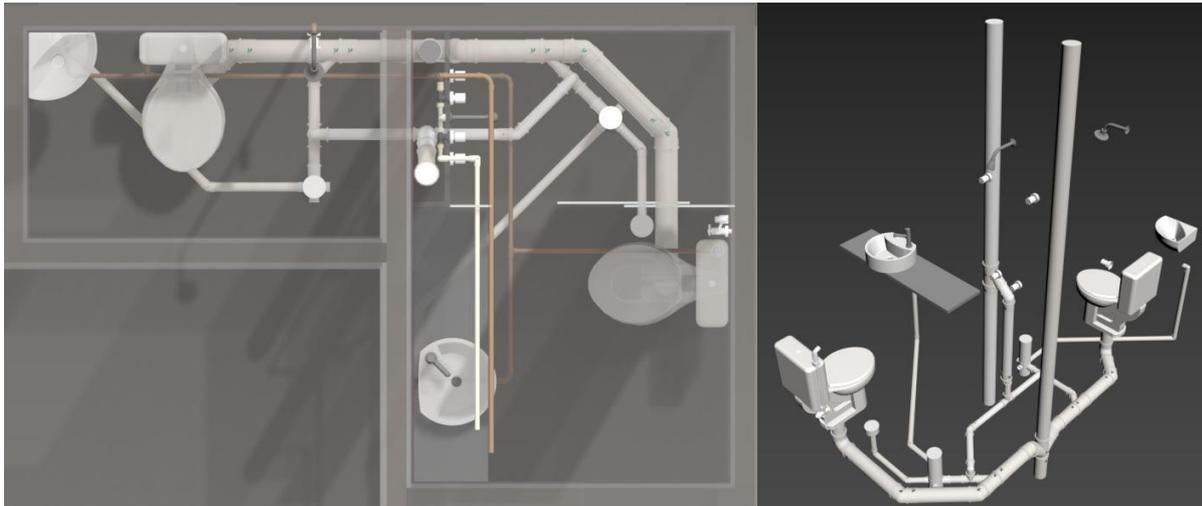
Planta baixa e vista isométrica do BH2 e BH3.
